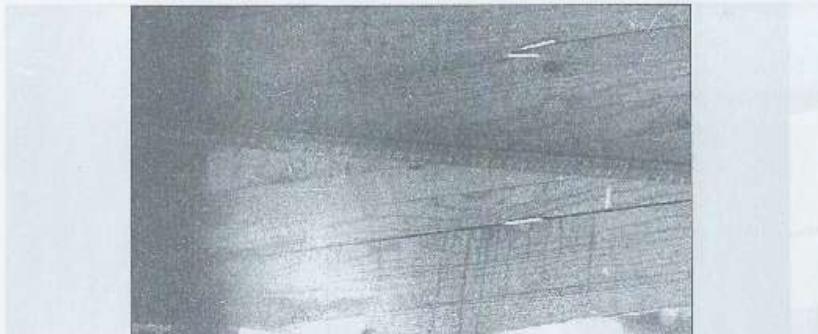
Трещины в приопорных зонах клееных блоков МДА (отмечены синичками) при выходе склоненного участка за пределы опорной площадки
